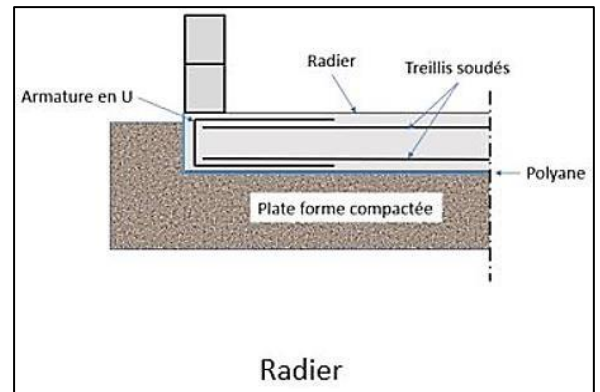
fondation / source : [beton/https://www.toutsurlebeton.fr/mise-en-oeuvre/le-radier-de-fondation-en-beton/](https://www.toutsurlebeton.fr/mise-en-oeuvre/le-radier-de-fondation-en-beton/)
